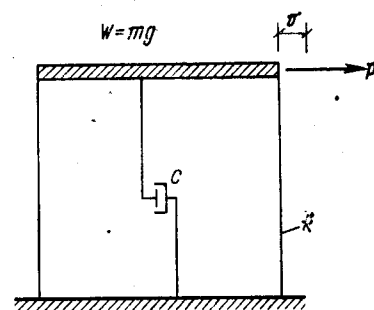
Вибрационные испытания одноэтажного здания (p — нагрузка от домкрата; k — общая жесткость)
